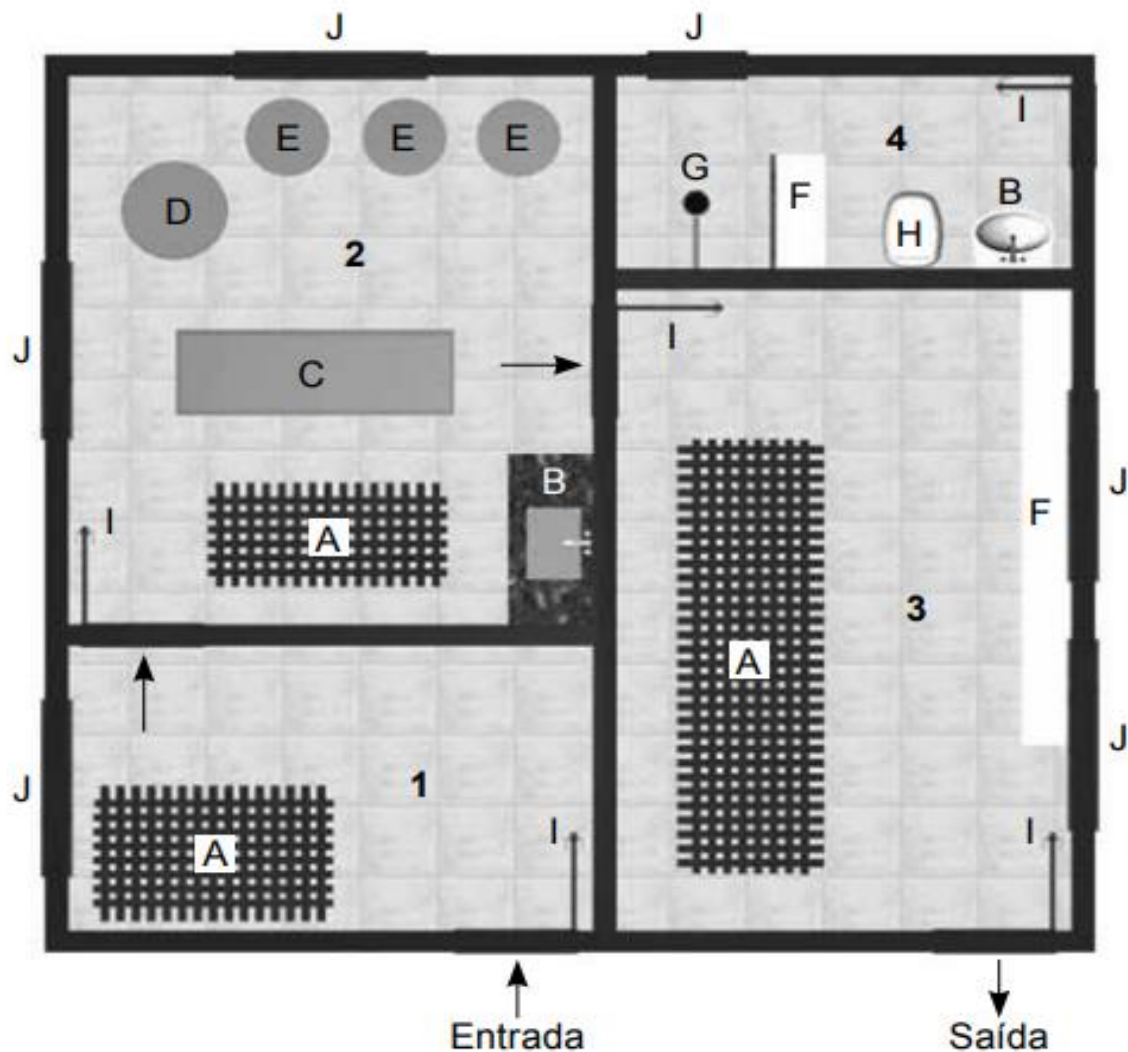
Planta baixa de uma casa do mel. 1- Recepção; 2- Área de manipulação; 3- Expedição; 4- Banheiro/Vestiário; A- Estrado; B- Pia; C- Mesa desoperculadora; D- Centrífuga; E- Decantador; F- Armário; G- Chuveiro; H- Sanitário; I- Porta; J- Janela.
